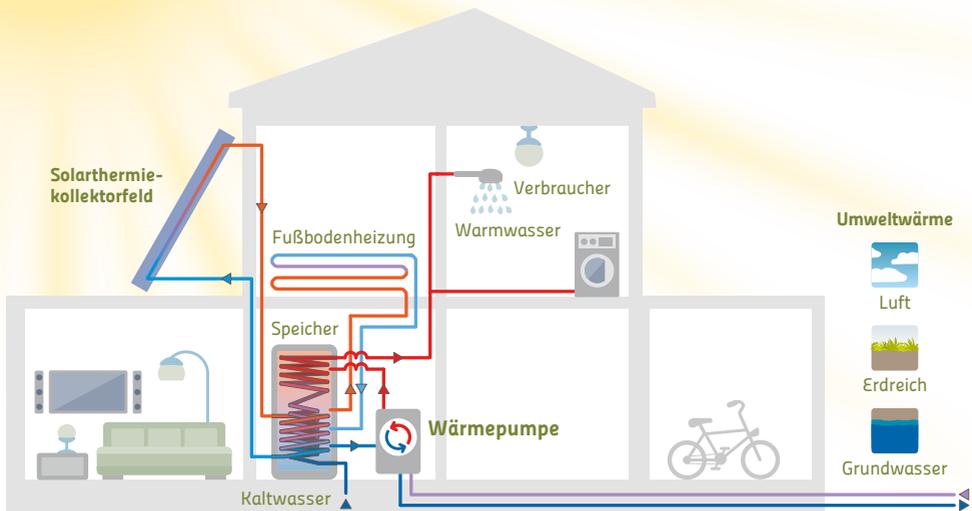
| Wärmepumpen-Anlage zur Heizwärme- und Trinkwasserwärmeversorgung mit Unterstützung einer Solarthermie-Anlage
